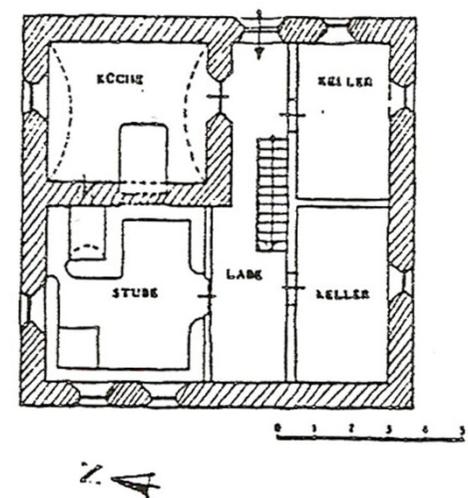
Mittelflurgrundriss, 15.-17. Jahrhundert
